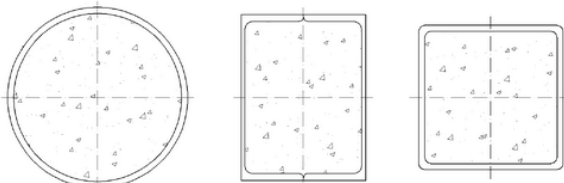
Поперечные сечения сталежелезобетонных конструкций третьего типа (трубобетон)
